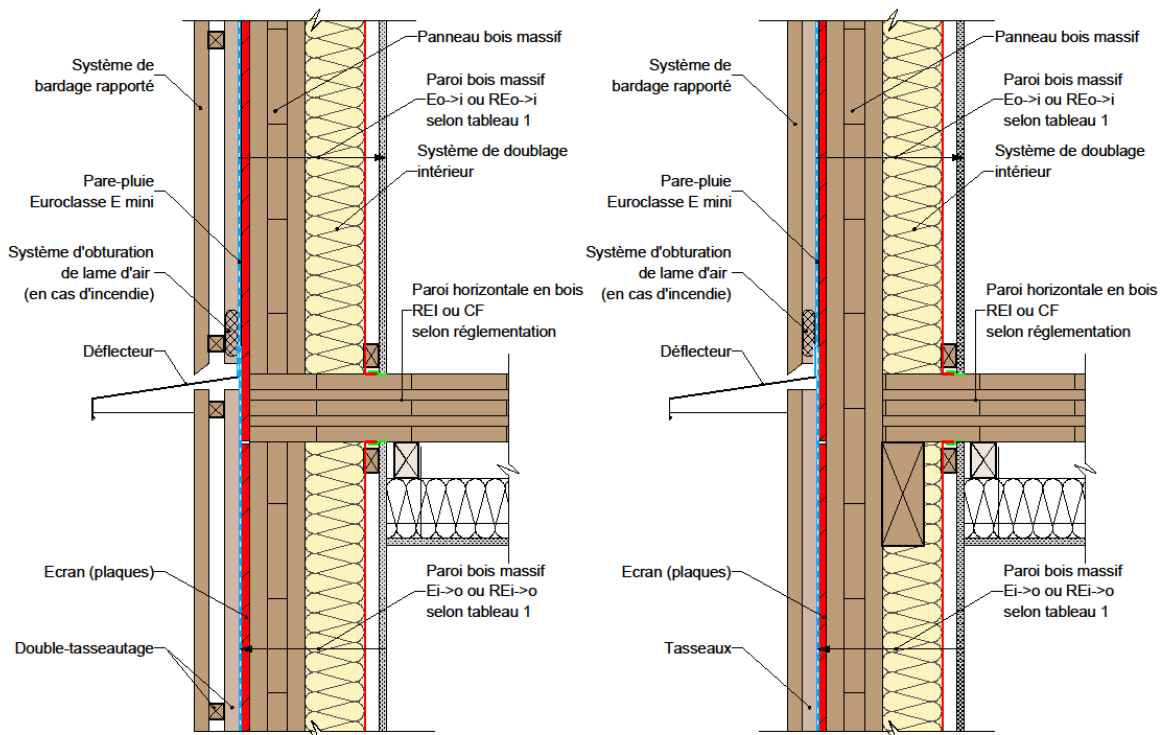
Façade/mur en panneaux bois massif contrecollés et contrecloués & plancher en panneau bois massif contrecollés et contrecloués.
